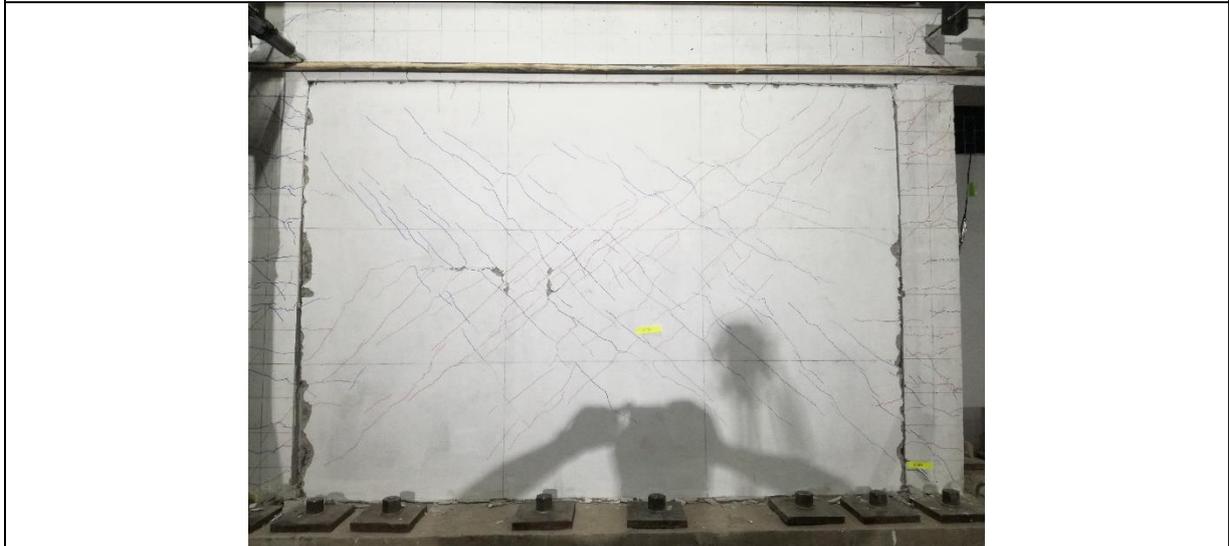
フェロセメント試験体のひび割れ発生状況
